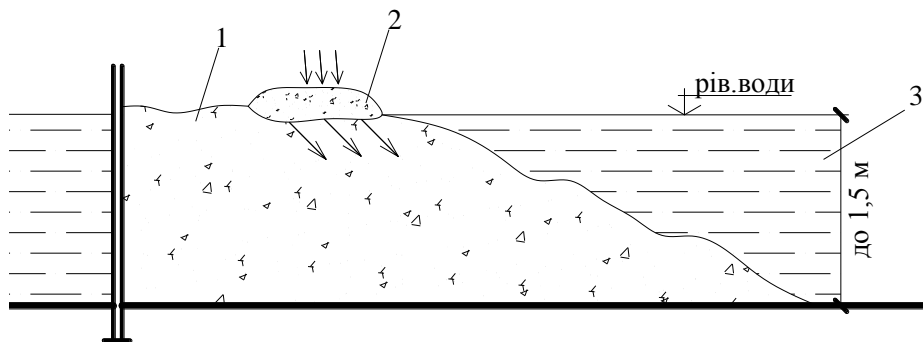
Бетонування методом утрамбування бетонної суміші:
